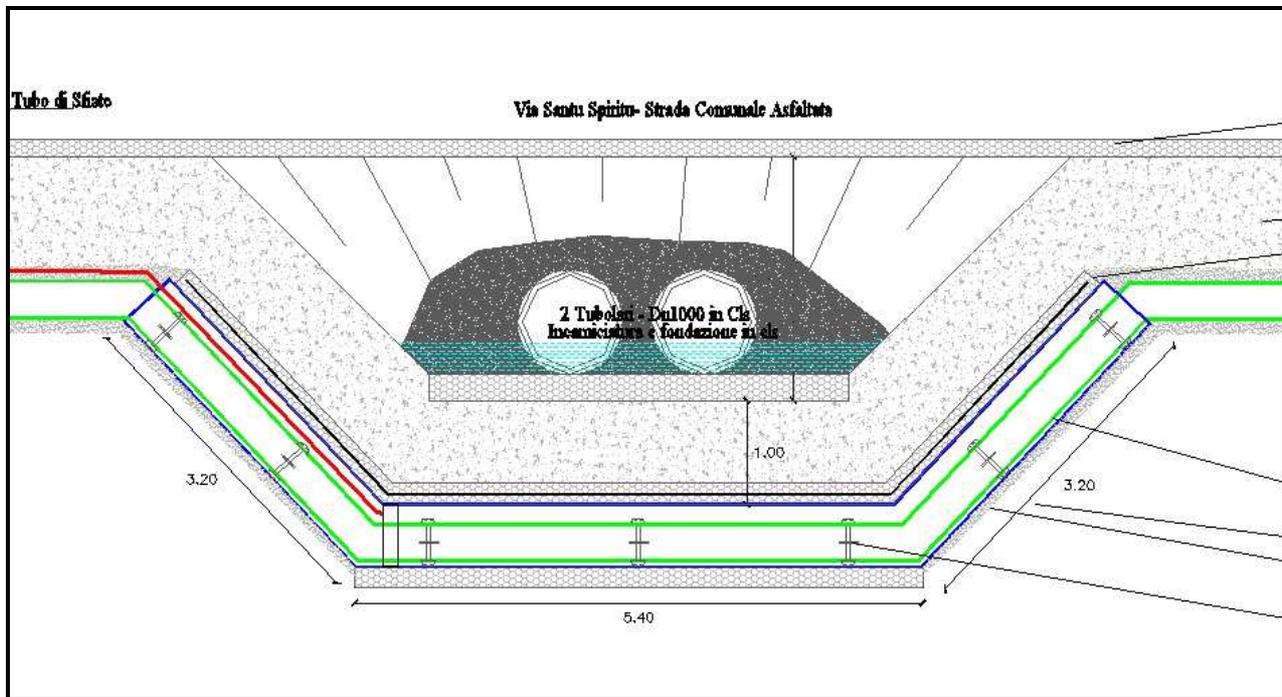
Particolare realizzativo dell'attraversamento in subalveo del rio Fenuju.
